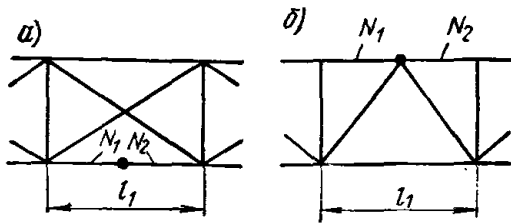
Схемы для определения расчетной длины элемента с различными усилиями N_1 и N_2 по его длине a — схема связей между фермами (вид сверху); b — схема фермы
